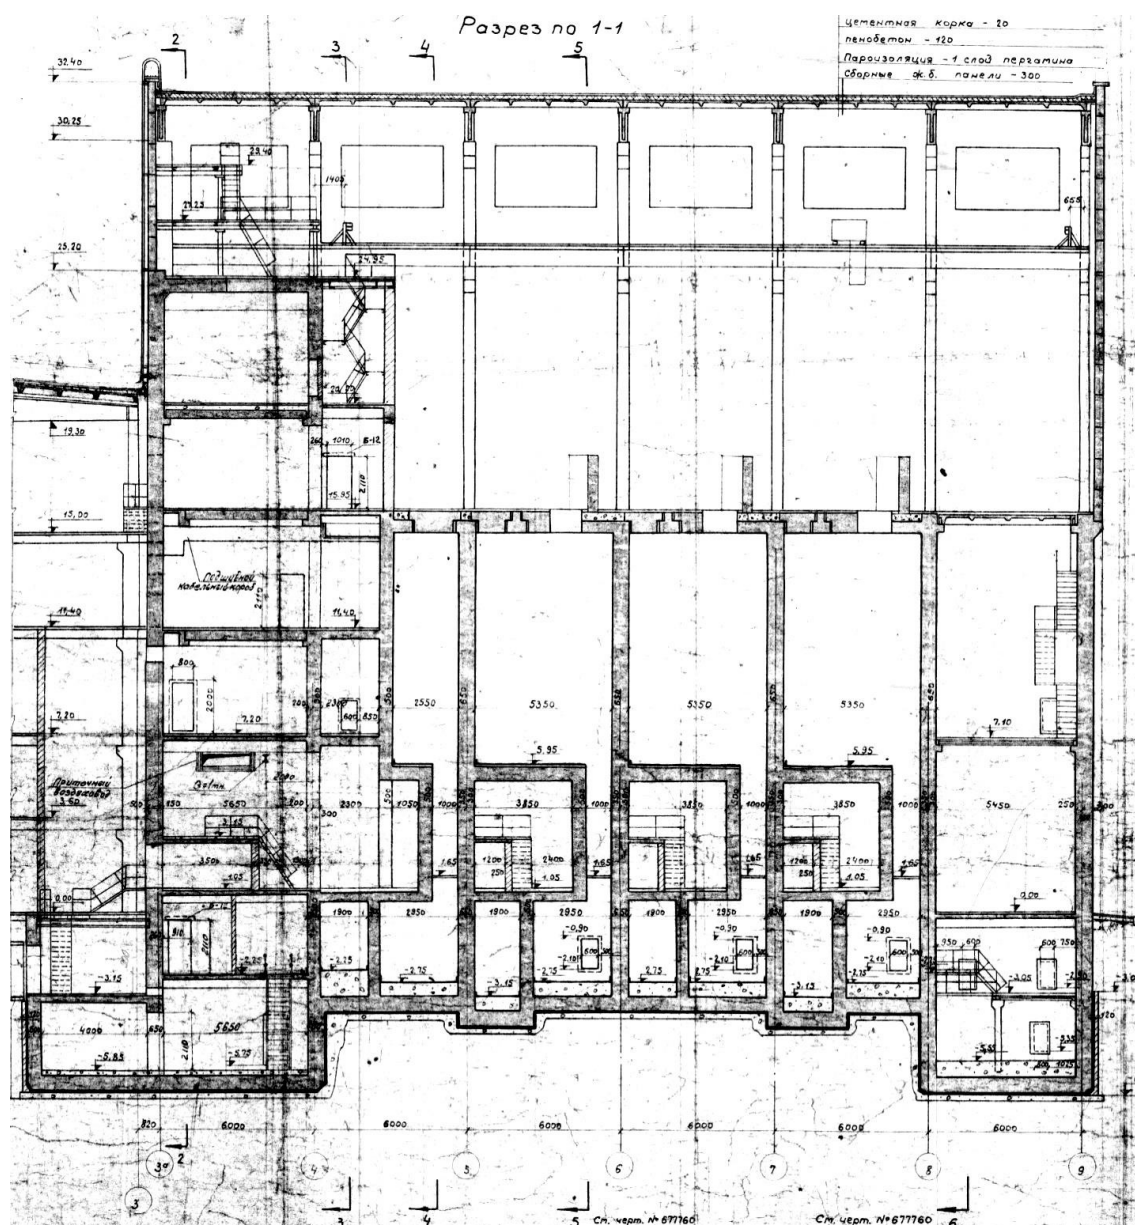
Эскиз поперечного разреза здания СВО
